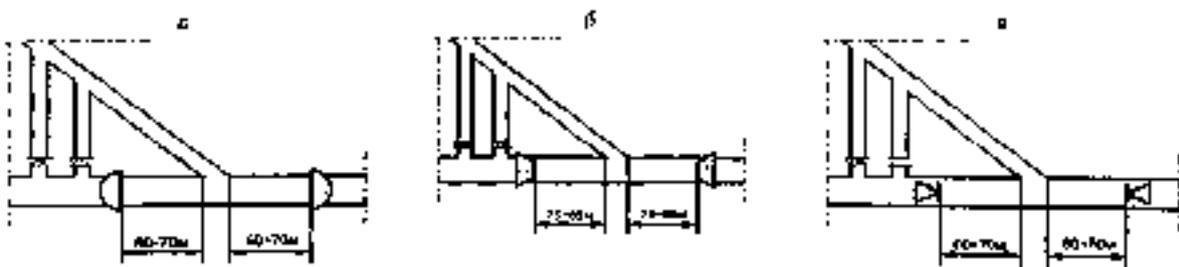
Схемы установки заслонов в действующей выработке с двух сторон от ее сопряжения с газодренажной выработкой
